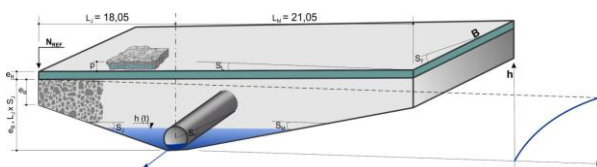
Detalhe do sistema de drenagem da base do pavimento permeável reservatório (Pinto, 2011)
